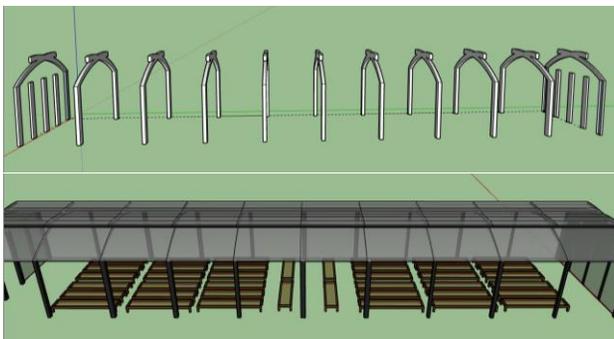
Características de los pilares de las estructuras laterales. Longitud total: 9 metros. Distancia entre pilares: 2.25 metros. Ancho del pilar: 10 centímetros. Altura del pilar: 4.90 metros
